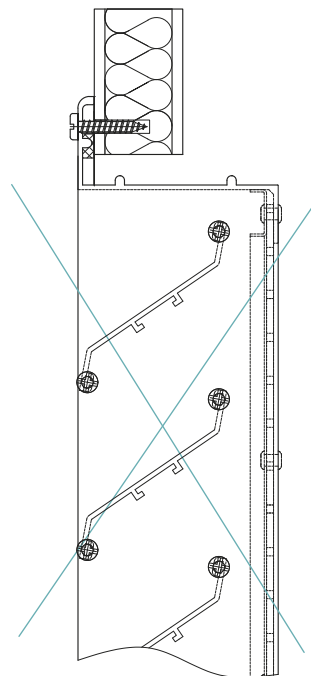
Montaż w ścianie murowanej lub betonowej.
